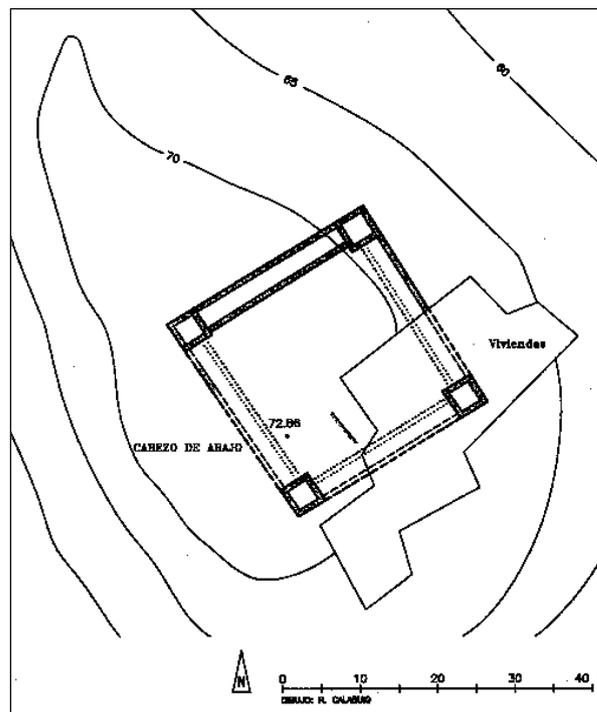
Cabezo de Abajo. Planimetría de estructuras.
